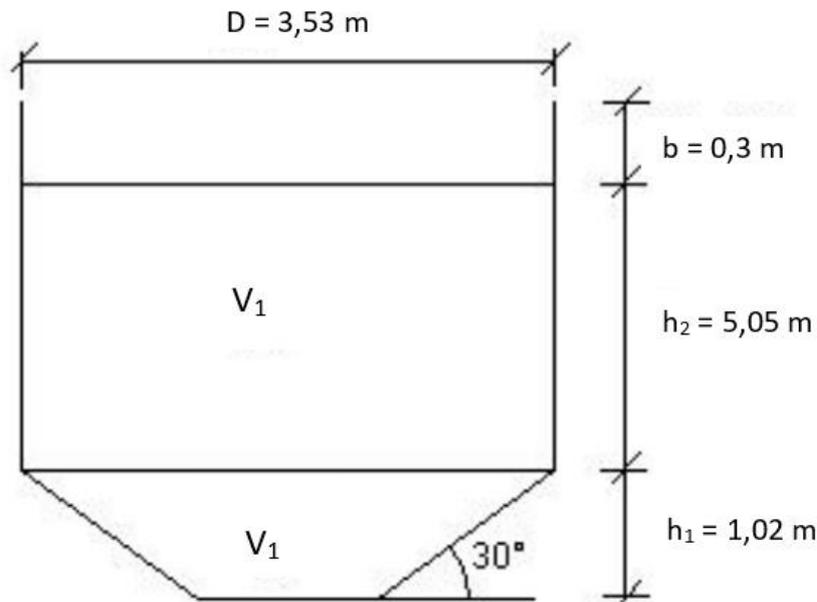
Alzado digester de un tanque Imhoff. [Fuente propia]
